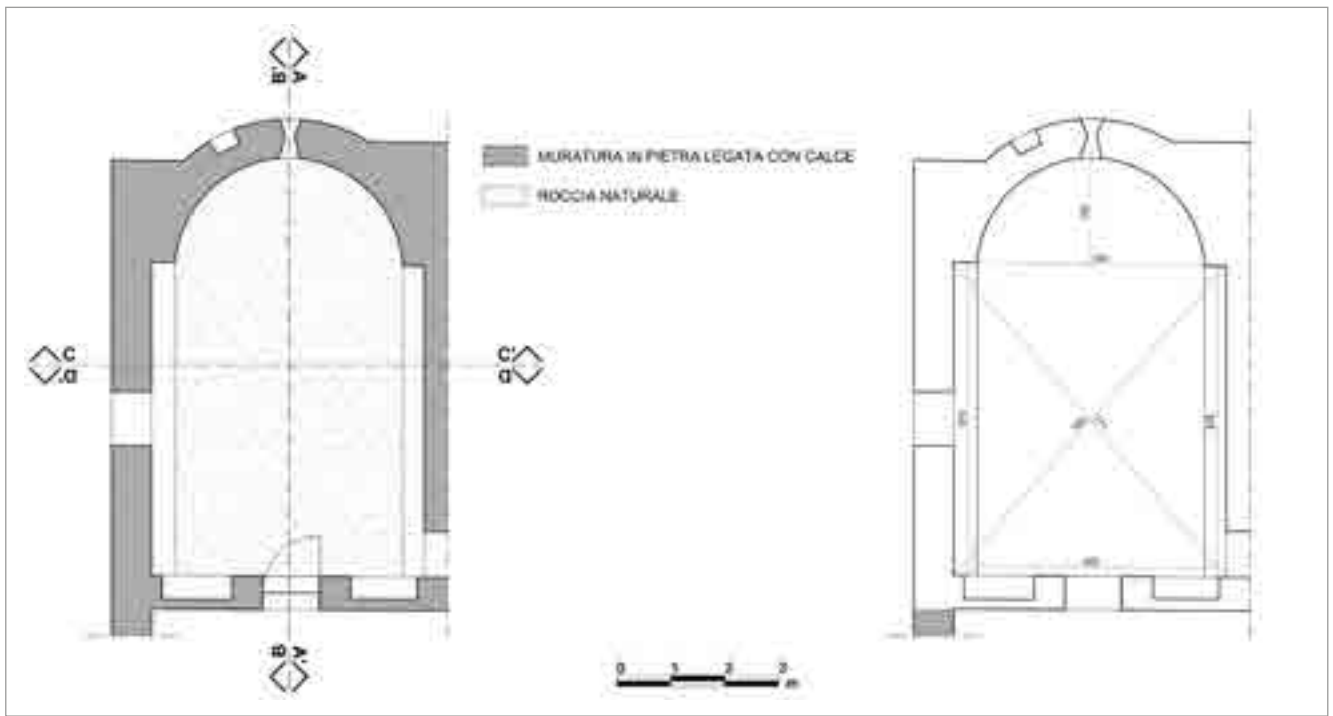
Pianta con indicazione delle sezioni e pianta quotata.
